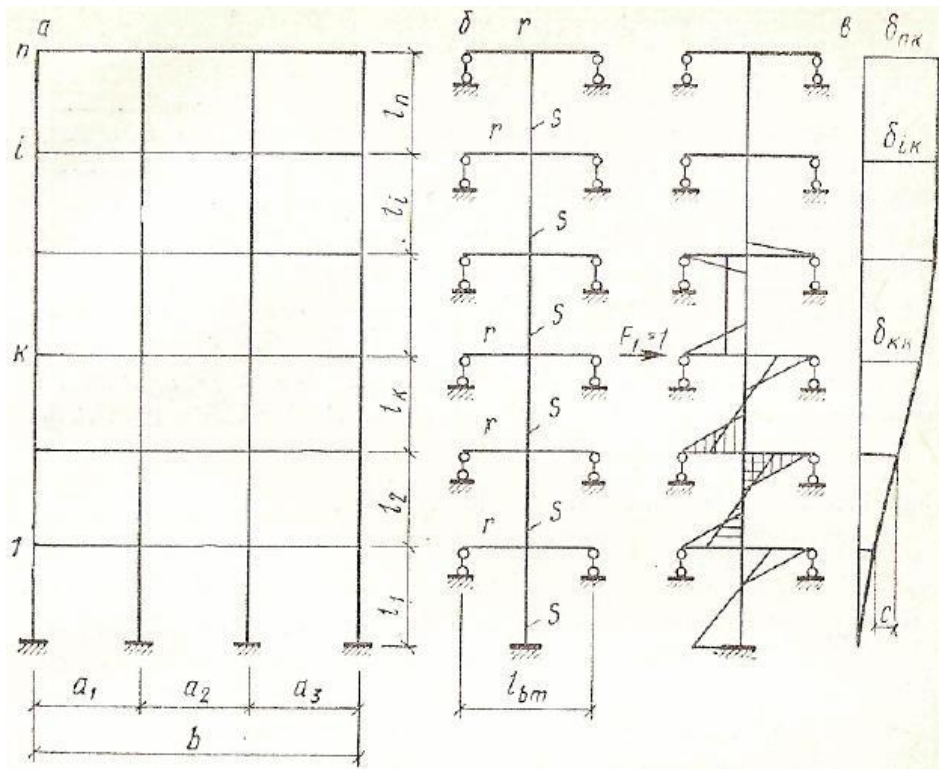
Расчетные схемы (а, б) и перемещения многоэтажной рамы (в)
